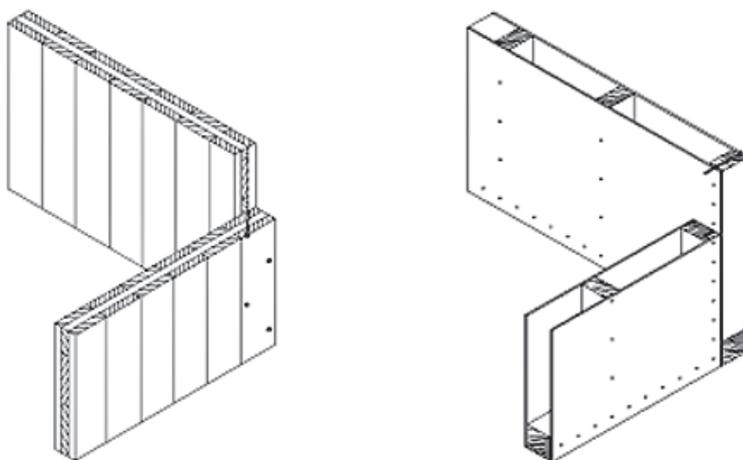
Collegamento d'angolo mediante viti, rispettivamente per pannelli XLAM e intelaiati
